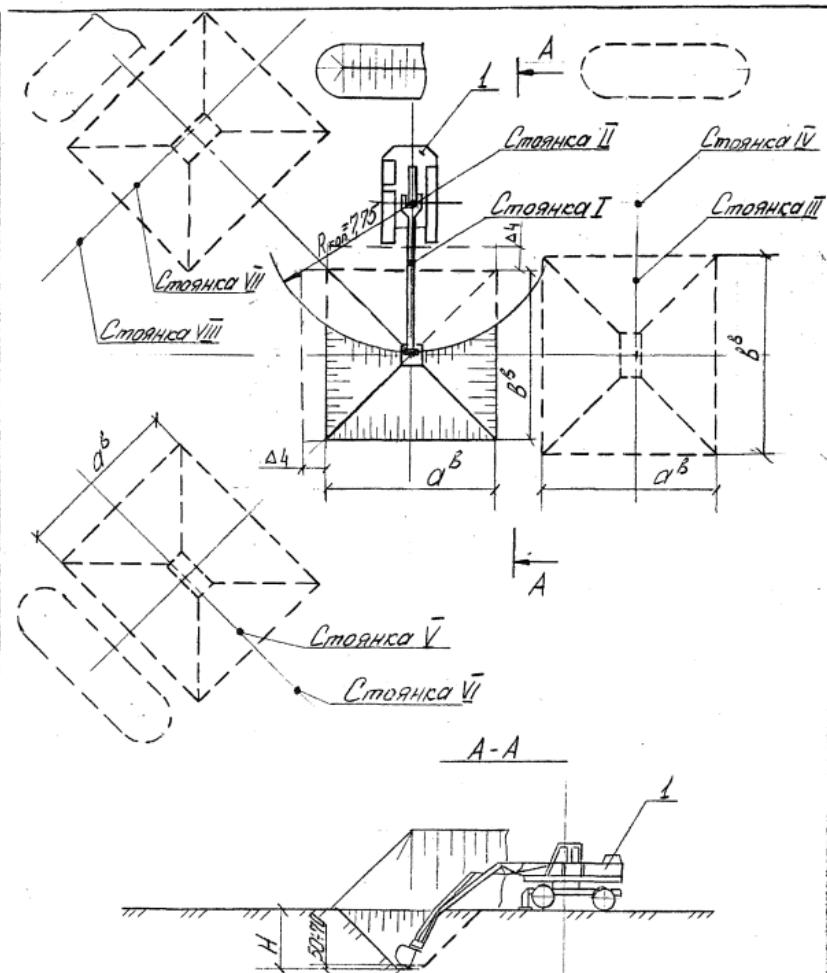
Схемы разработки котлованов под опоры с четырьмя котлованами
